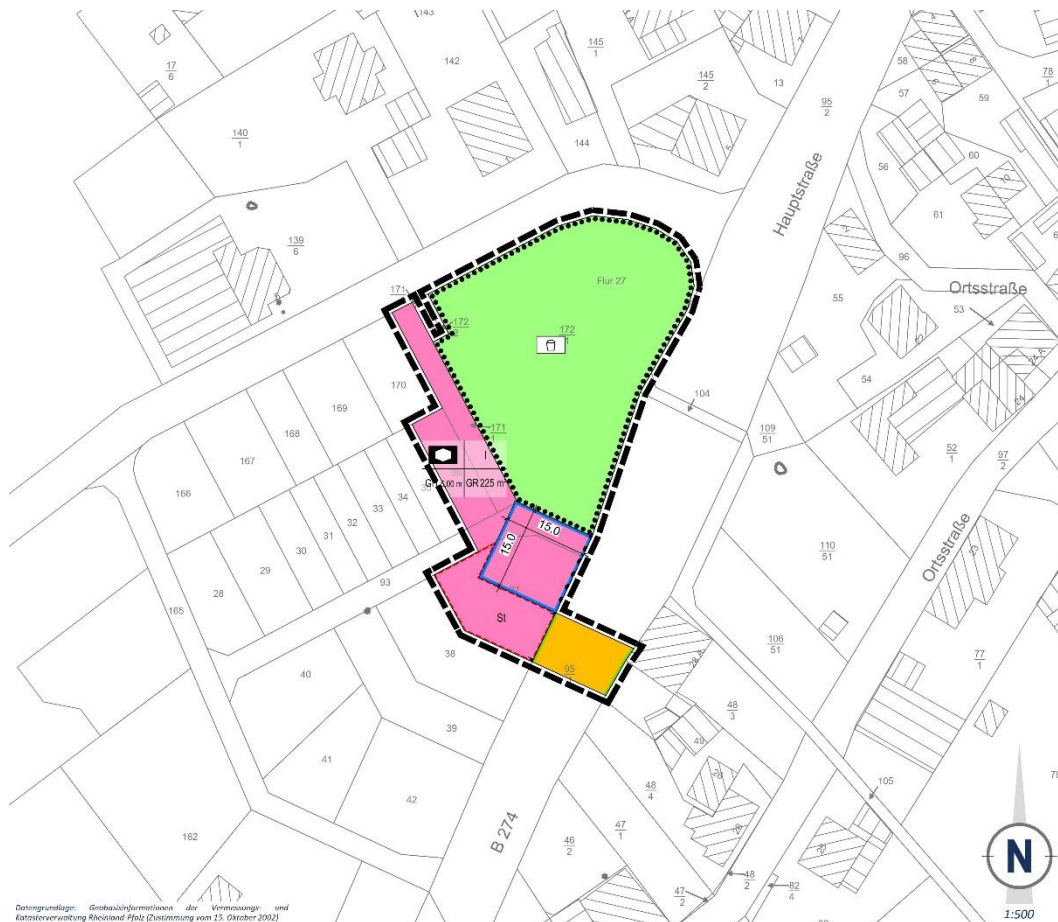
Entwurf Bebauungsplan „Unter dem Rheinweg, 2. Änderung“ (Stand
